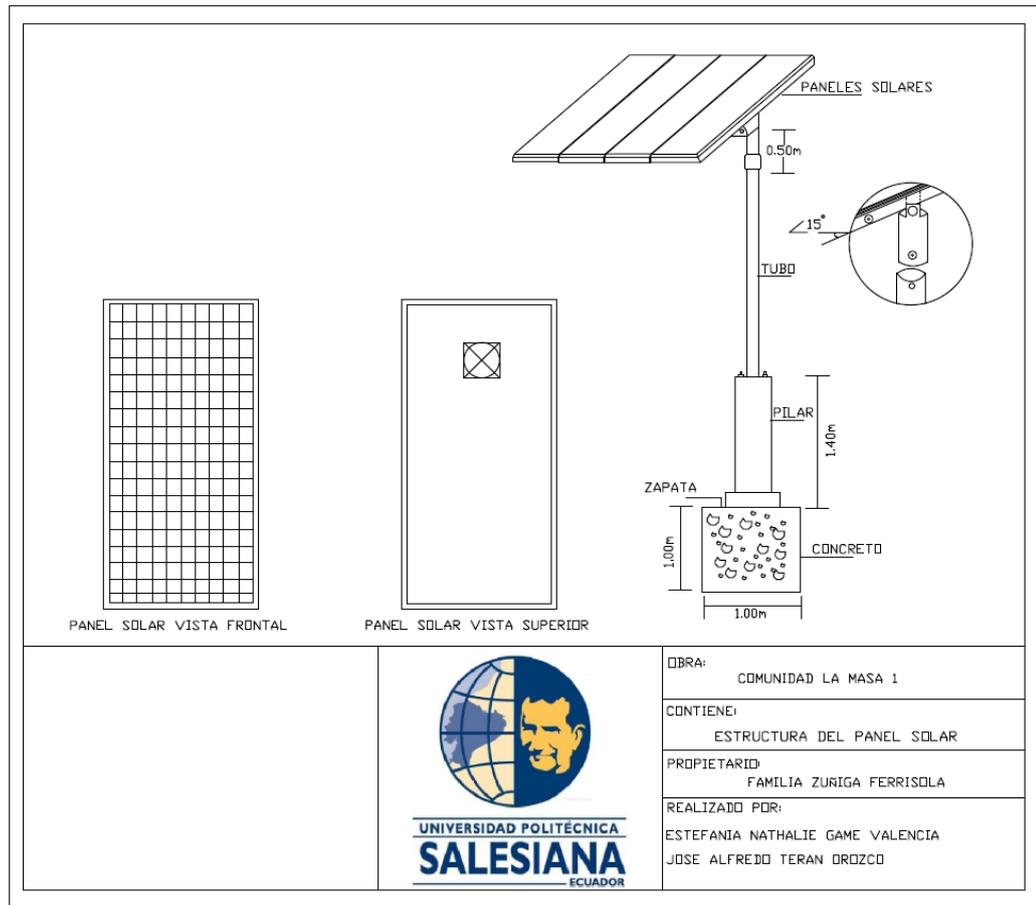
Estructura del panel solar a instalar en la vivienda (Fuente: Autores).
